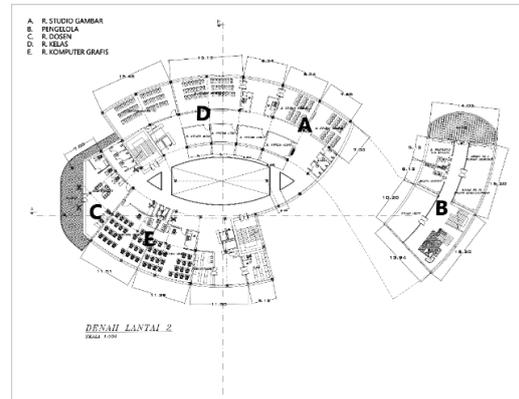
Layout Plan (Sumber : Penulis, 2022)
